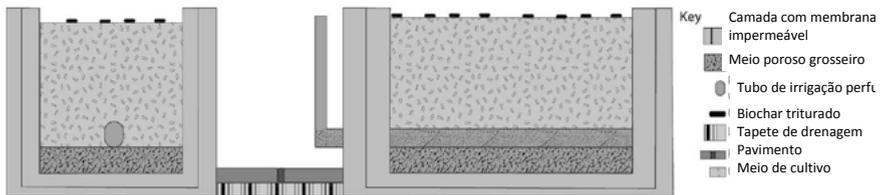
Construção de um canteiro de cultivo no telhado.
